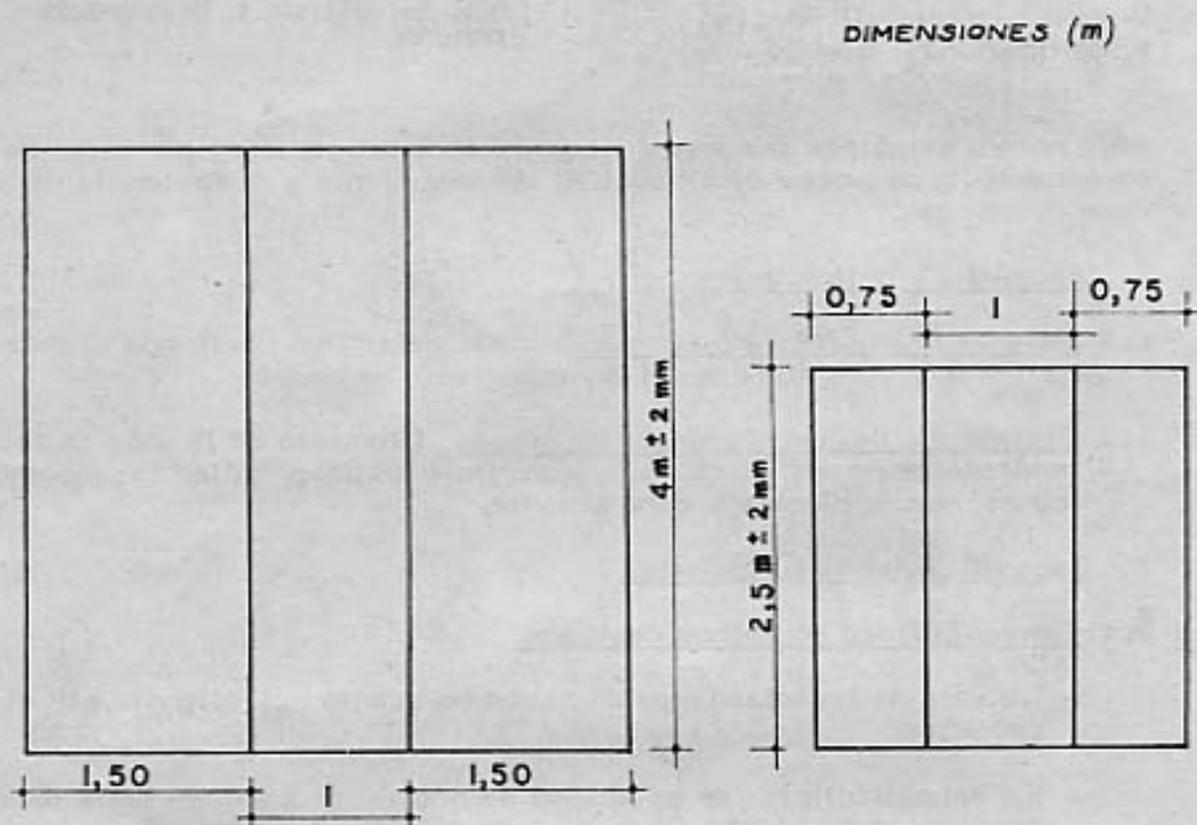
Planta de las plataformas de 4 m y 2,5 m
